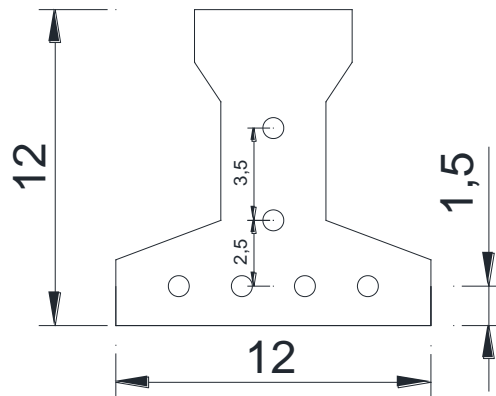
SECCIÓN HOMOGENEIZADA PARA HORMIGÓN
